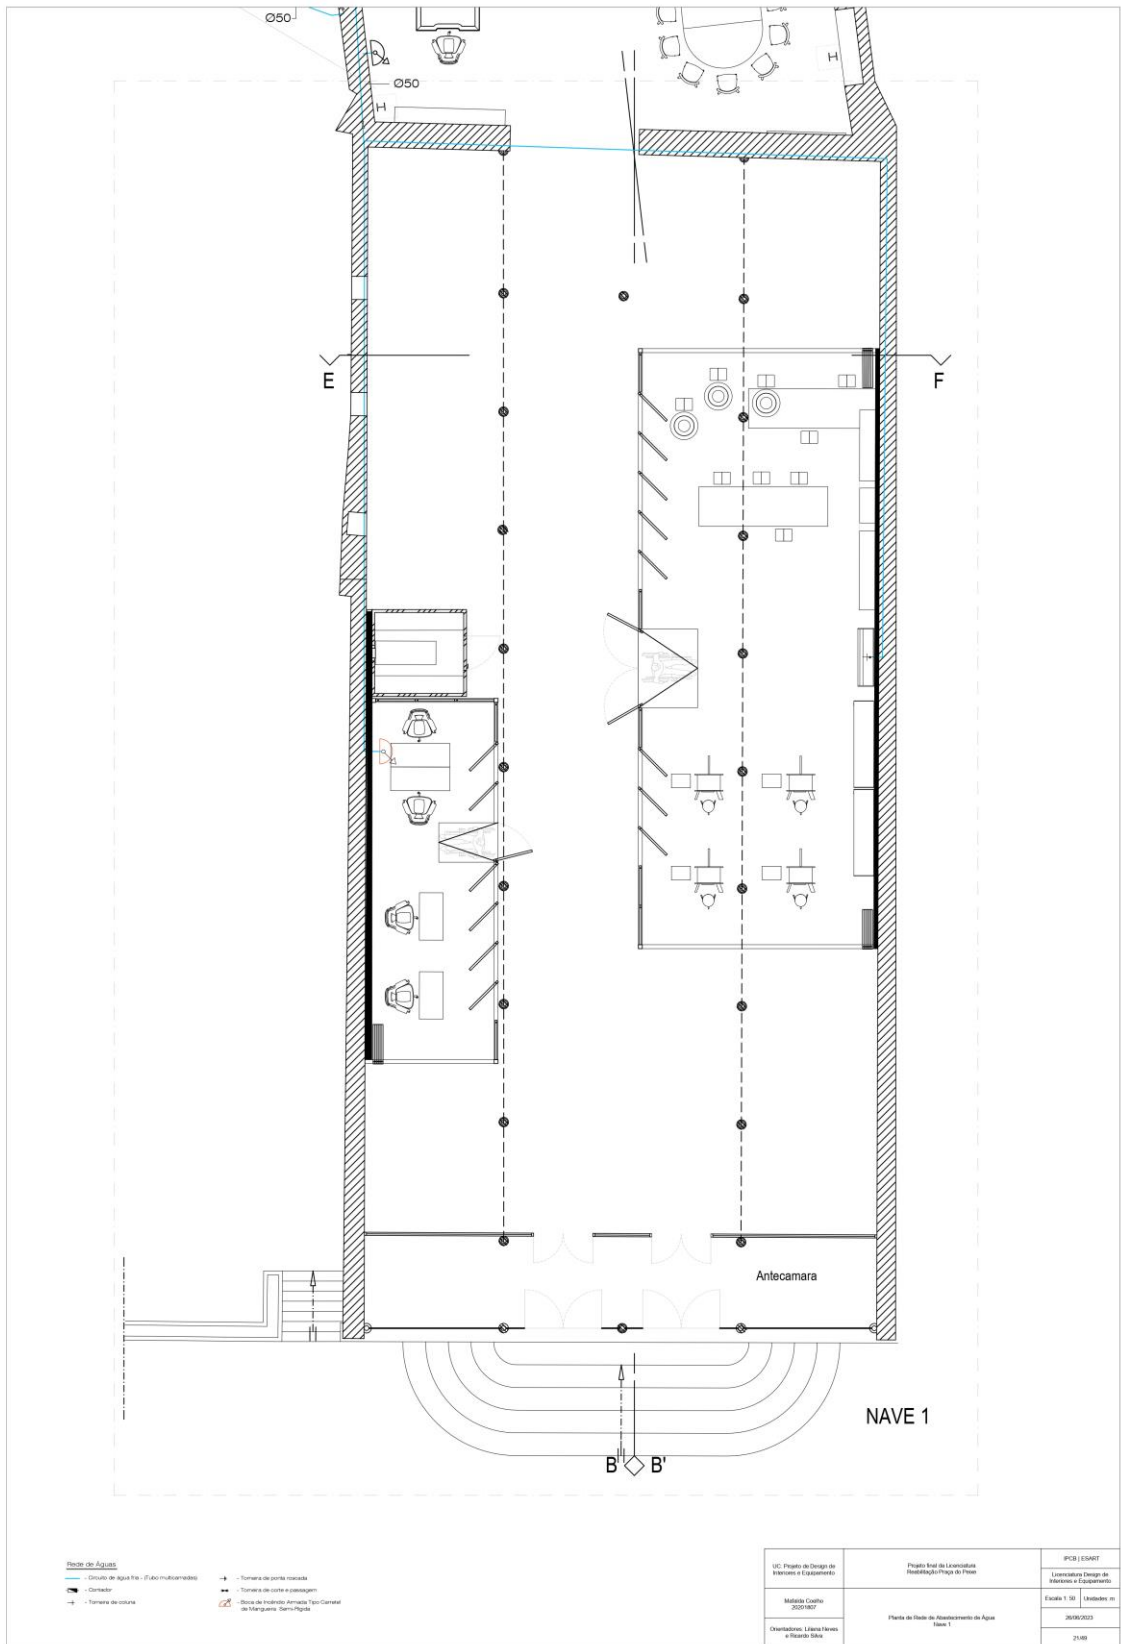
Planta de Rede de Abastecimento de Água Nave 1
